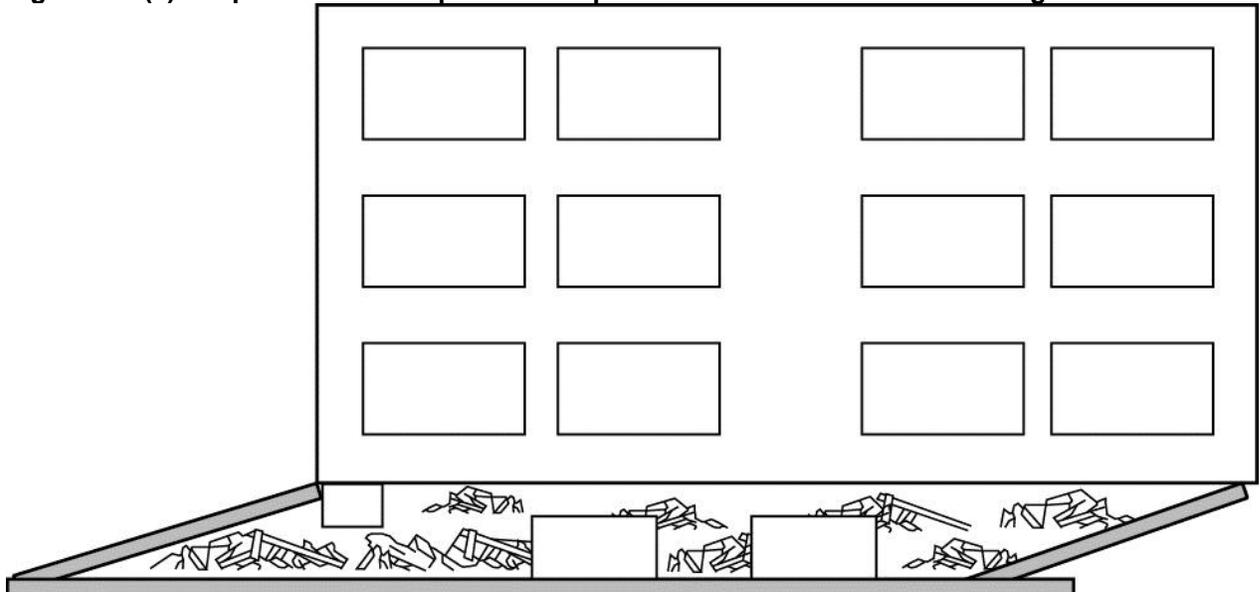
(b) Modelo de la pared-Fall Collapse - Pesado Wall - URM construcción.
